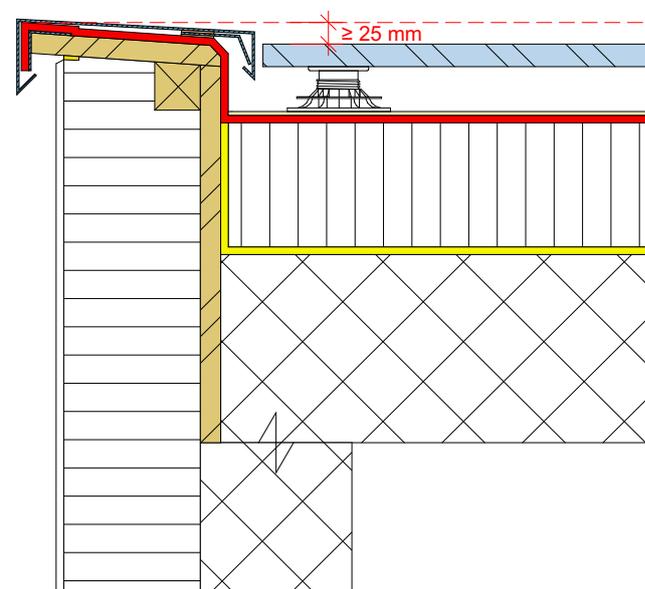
Il bordo del tetto con protezione antitrabocco deve essere sopraelevato di almeno 25 mm rispetto allo strato protettivo e di usura. Norma 271:2021 Art. 2.8.1.6 Immagine 8
